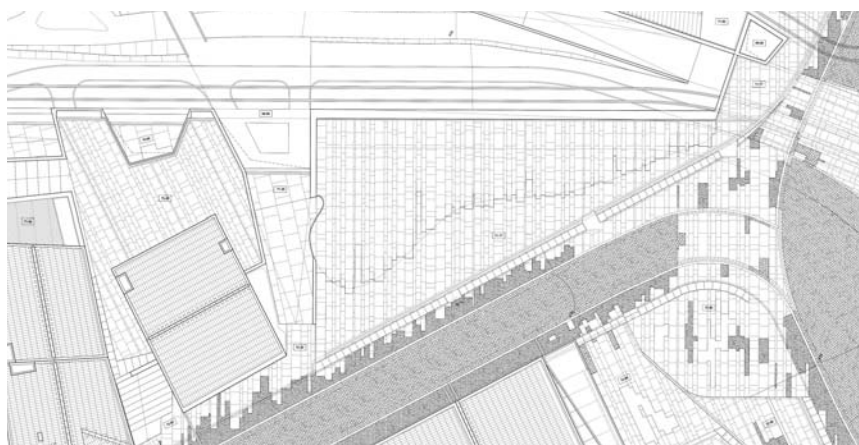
Planta final de pavimentos do Largo do Cruzeiro no contexto urbano (1:125): Traçado final da ‘dobra’ sobre o mirante.
